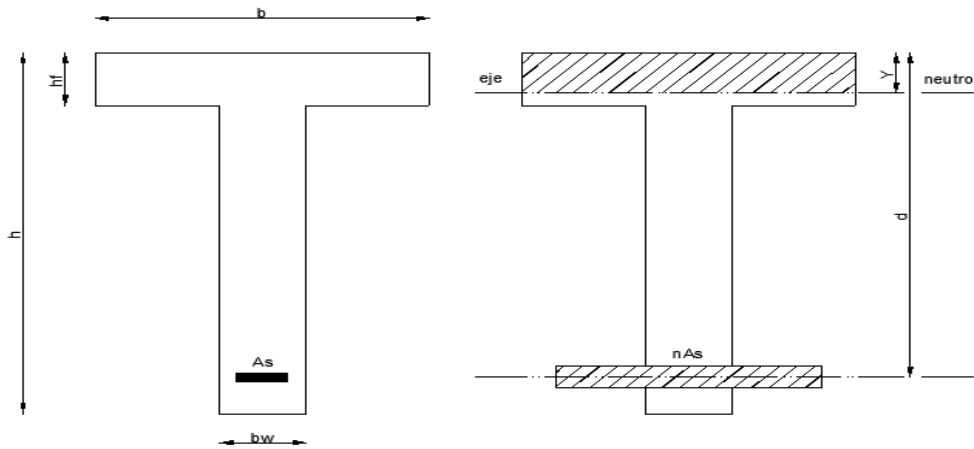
CORTE TÍPICO DE UNA SECCIÓN FISURADA
